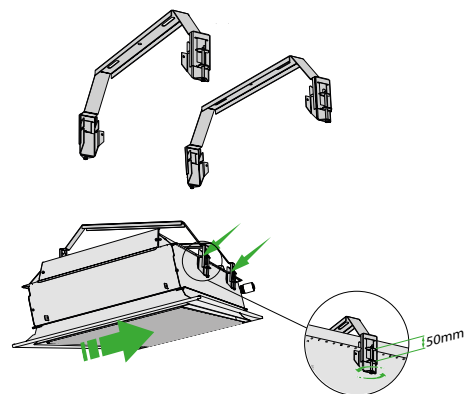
Aufhängung mit Schnellspanner PARASOL Z SCHNELLSPANNSATZ
